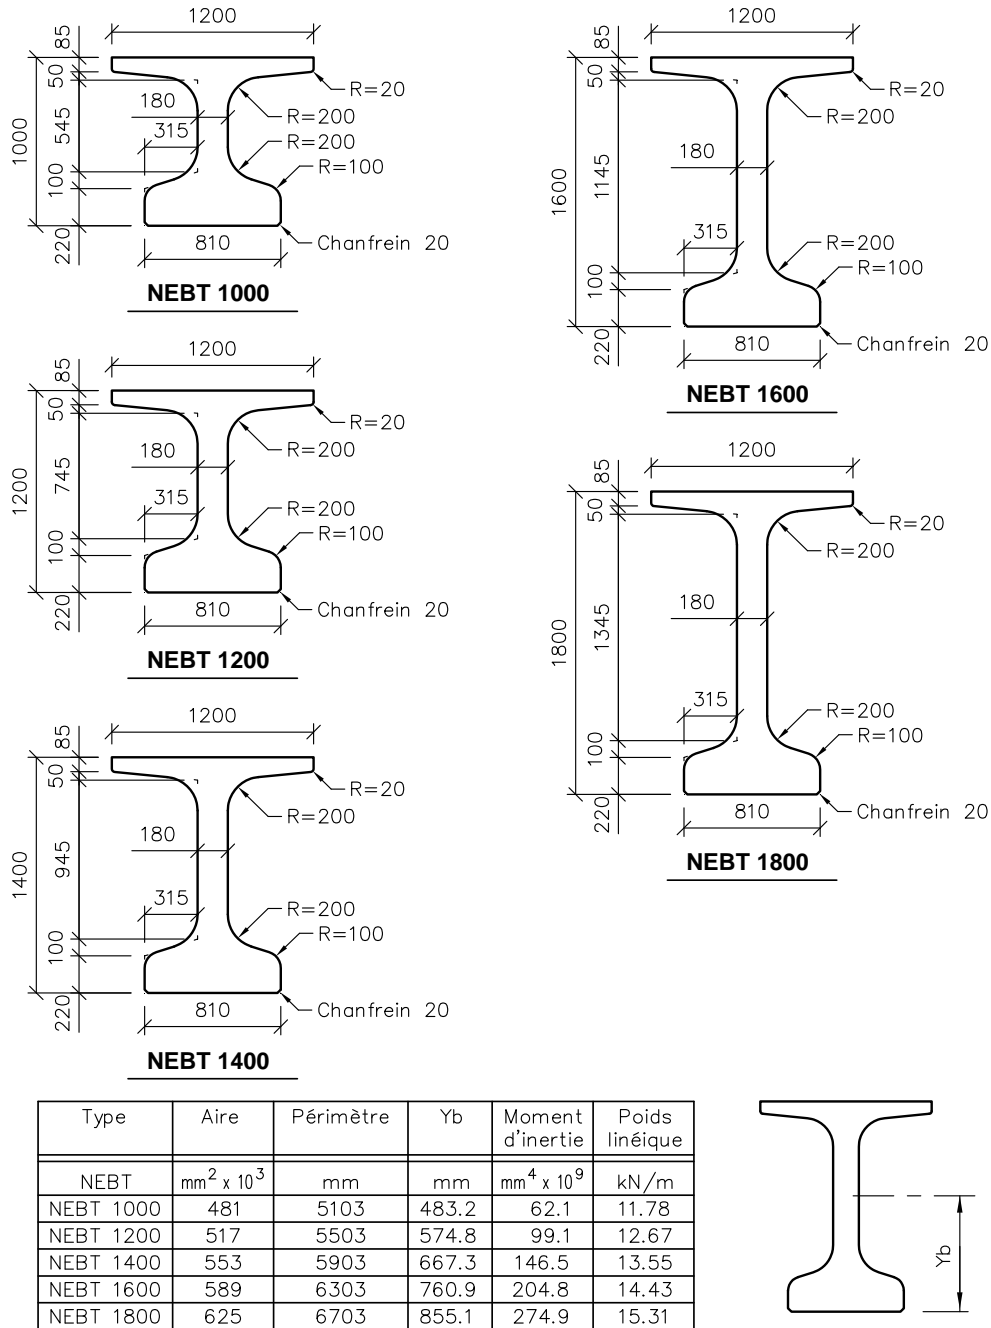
Caractéristiques des poutres préfabriquées de type NEBT
